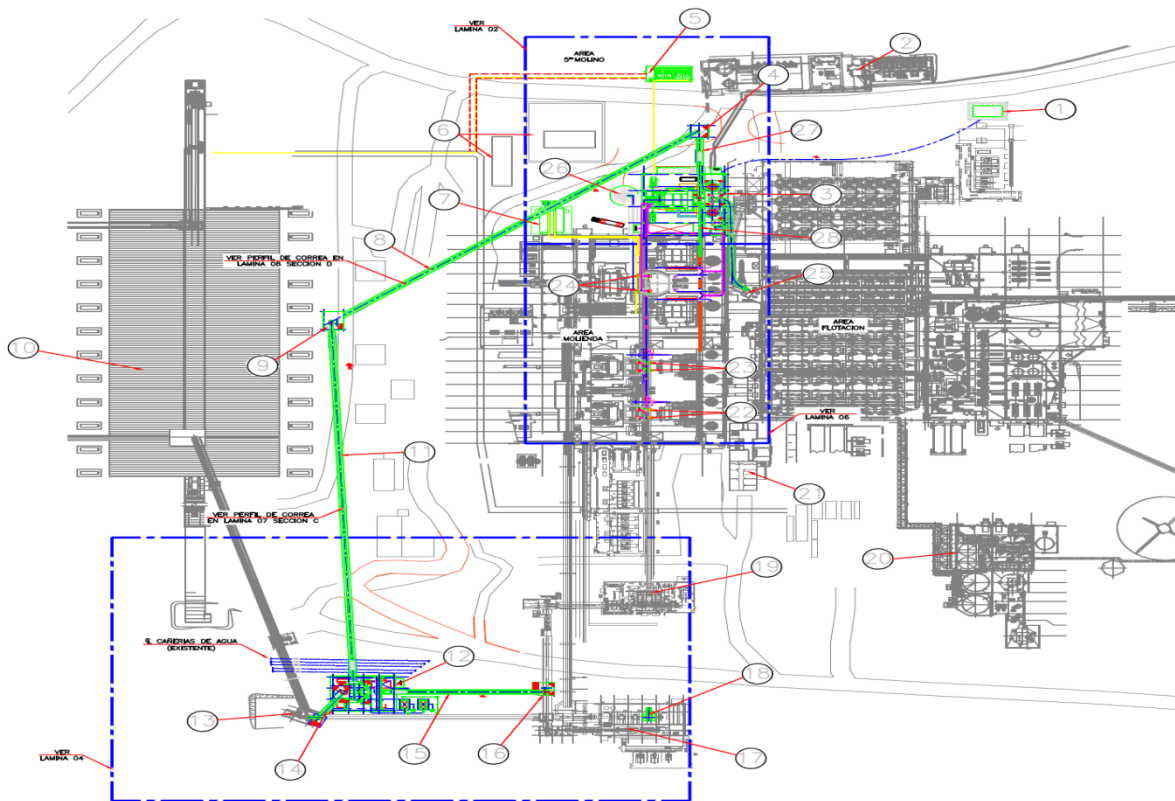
Layout Preliminar Proyecto – Alternativa 2A
